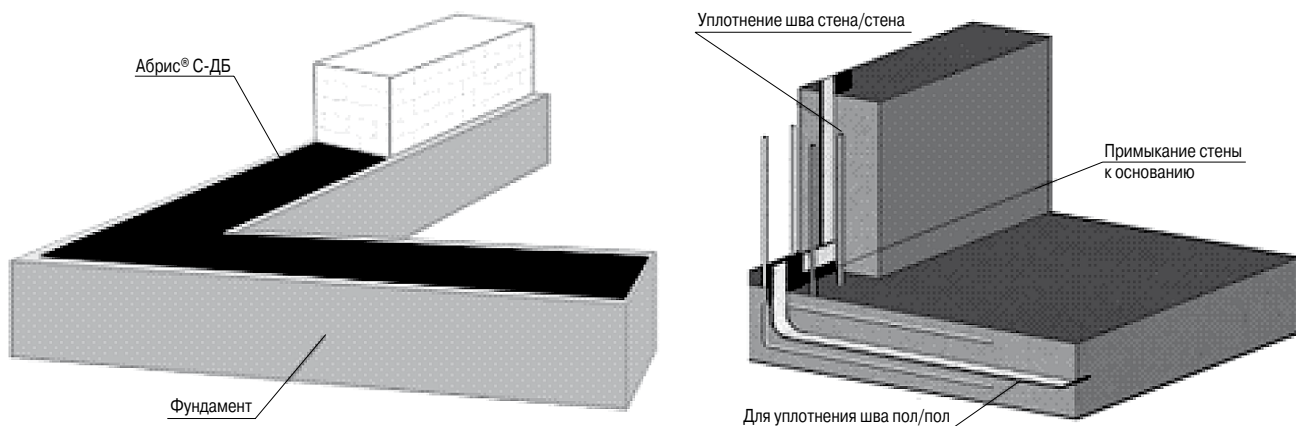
Уплотнение мест примыкания фундамент/стена, пол/стена, стена/стена и др. с использованием Абрис® С-ДБ
